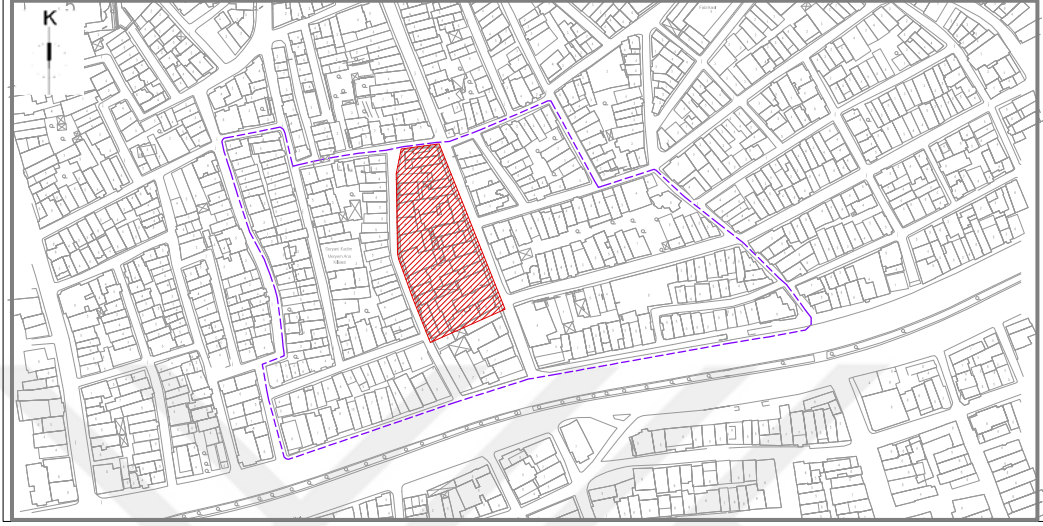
386 Ada 2007 Onaylı Avan Projenin Vaziyet Planı [4]
